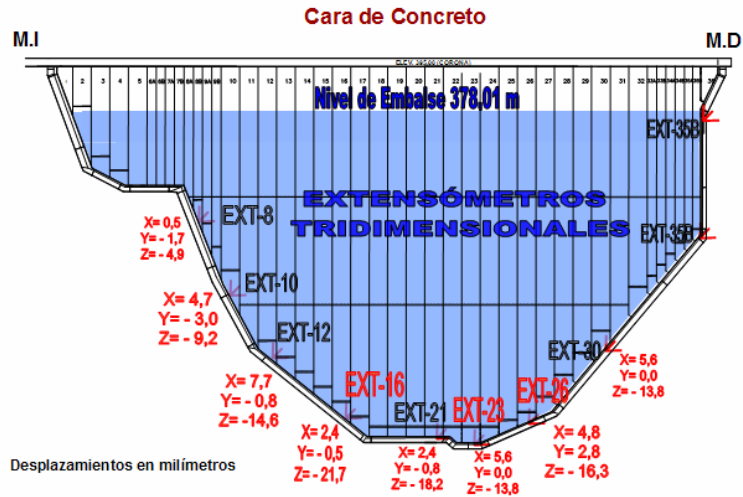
COMPORTAMIENTO DE LA JUNTA PERIMETRAL DESPUÉS DEL PRIMER LLENADO
